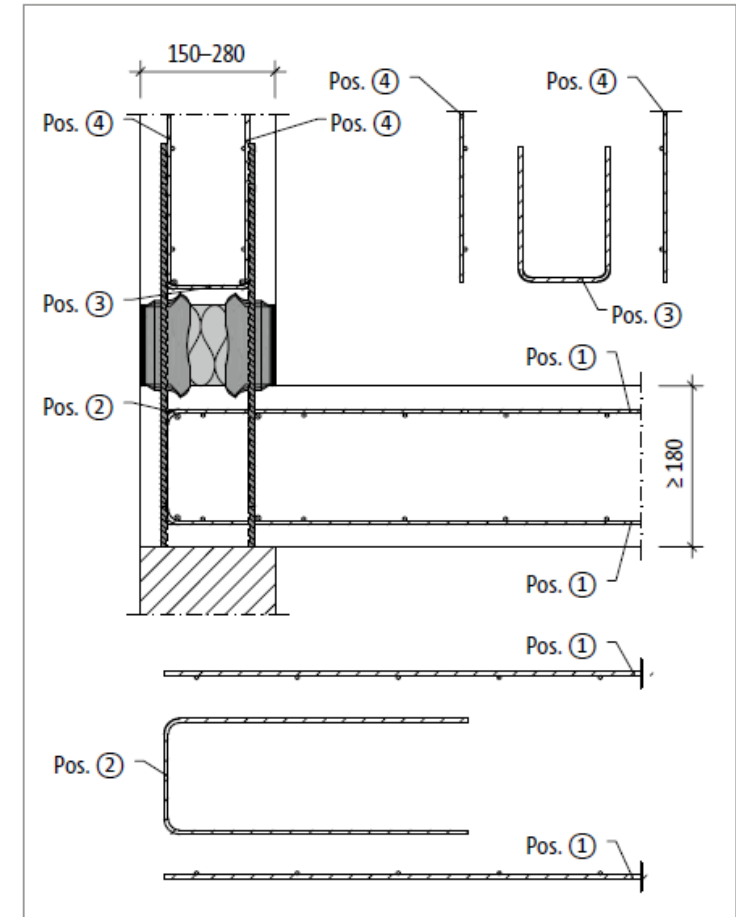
Schöck Isokorb® CXT Typ A: Bauseitige Bewehrung
